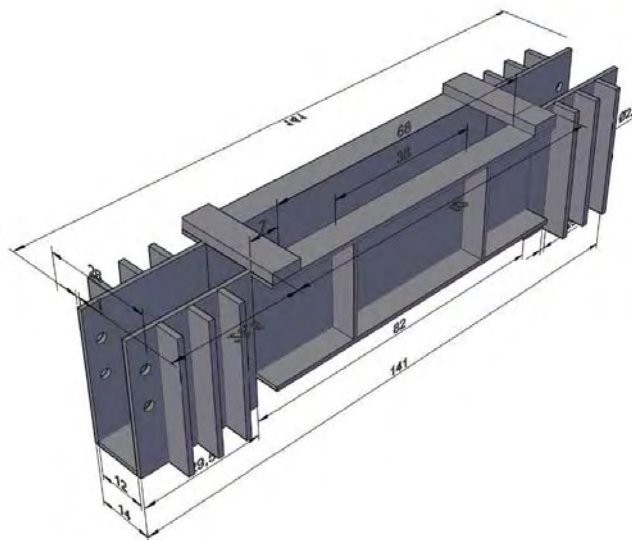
Diseño de viga de reacción existente con reforzamientos
